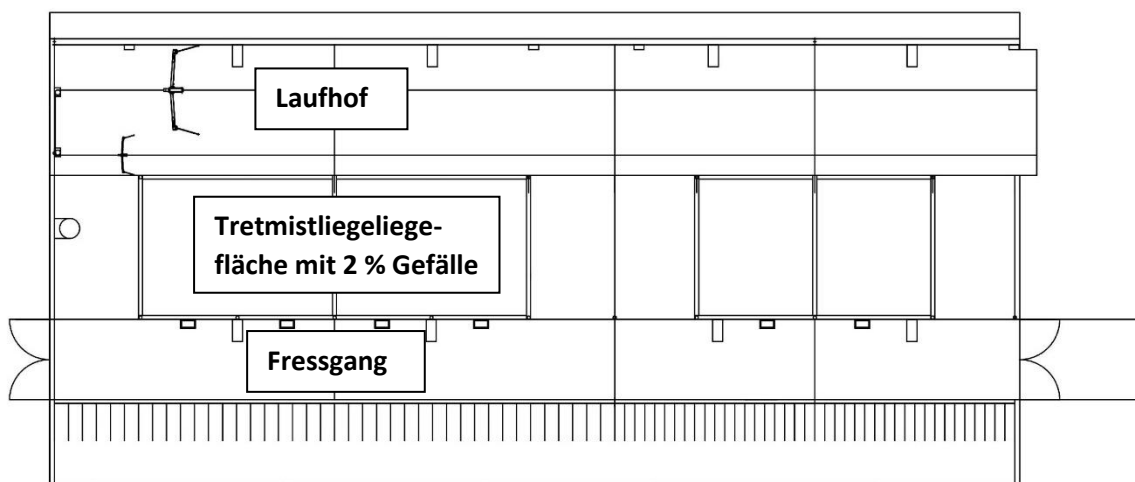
Schematischer Grundriss des Mutterkuhstalls mit Weidezugang
